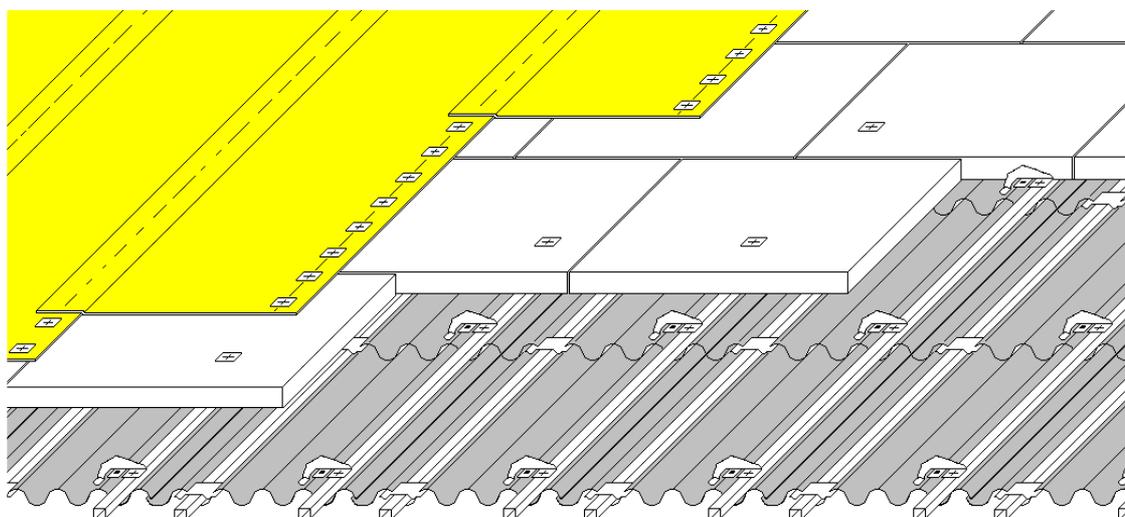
Soudure en noue sur bande alkorPLAN F
